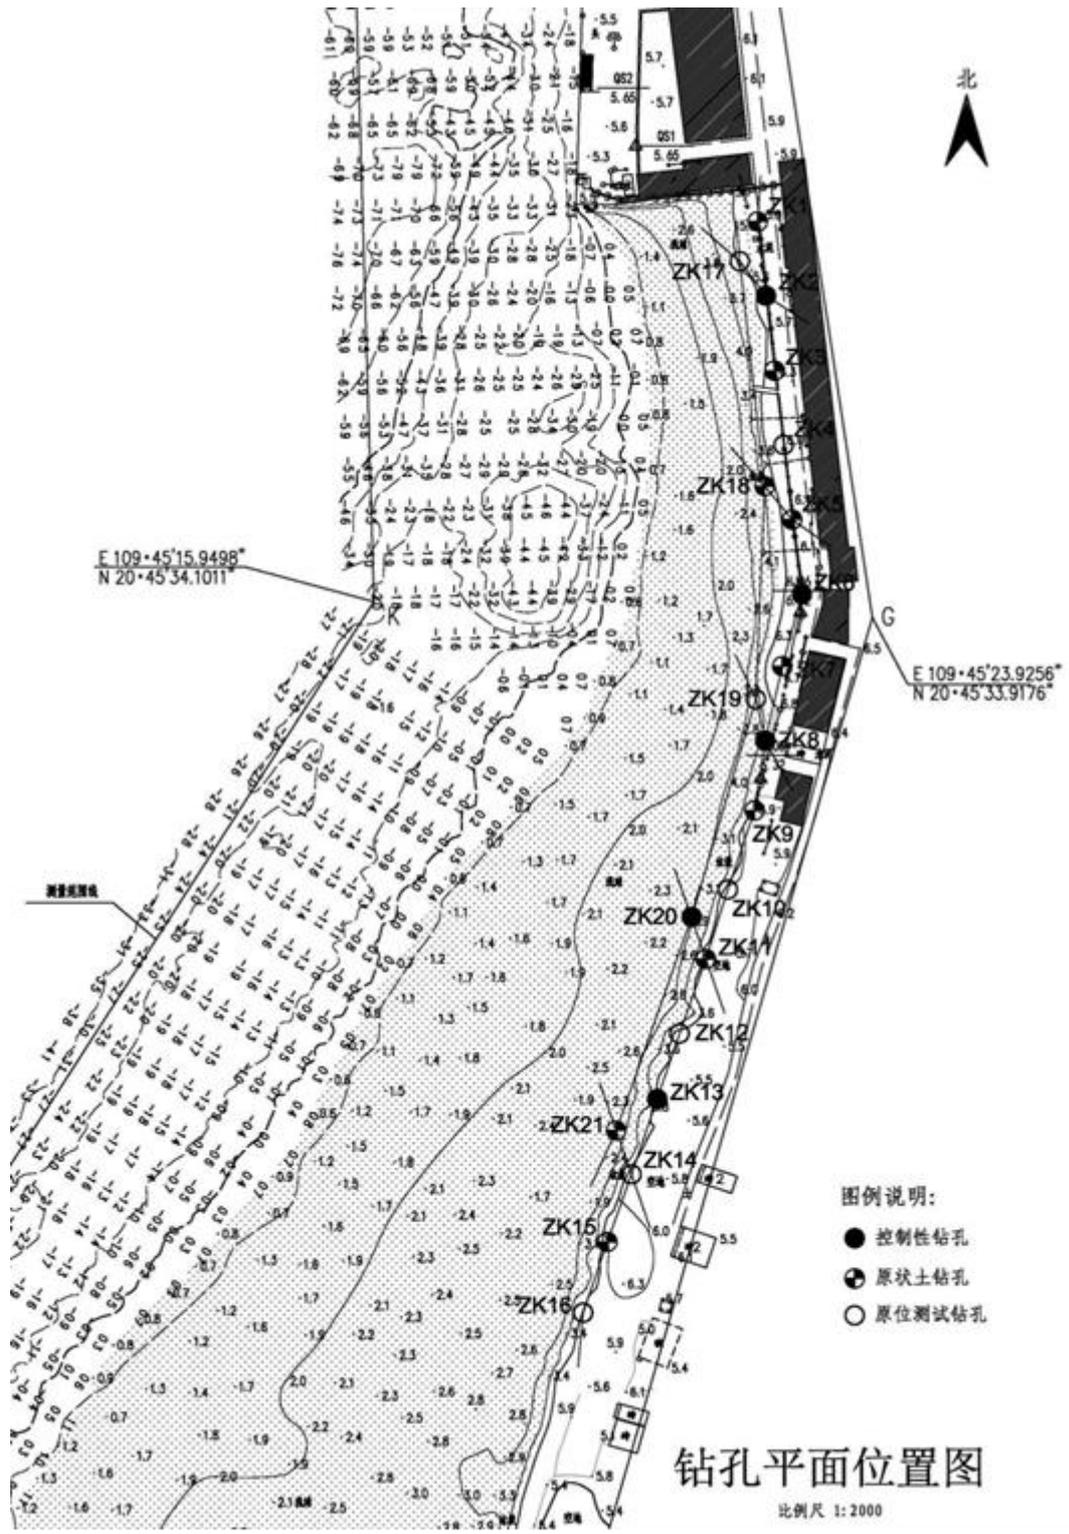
钻孔平面布置图 (企水港沿岸)
